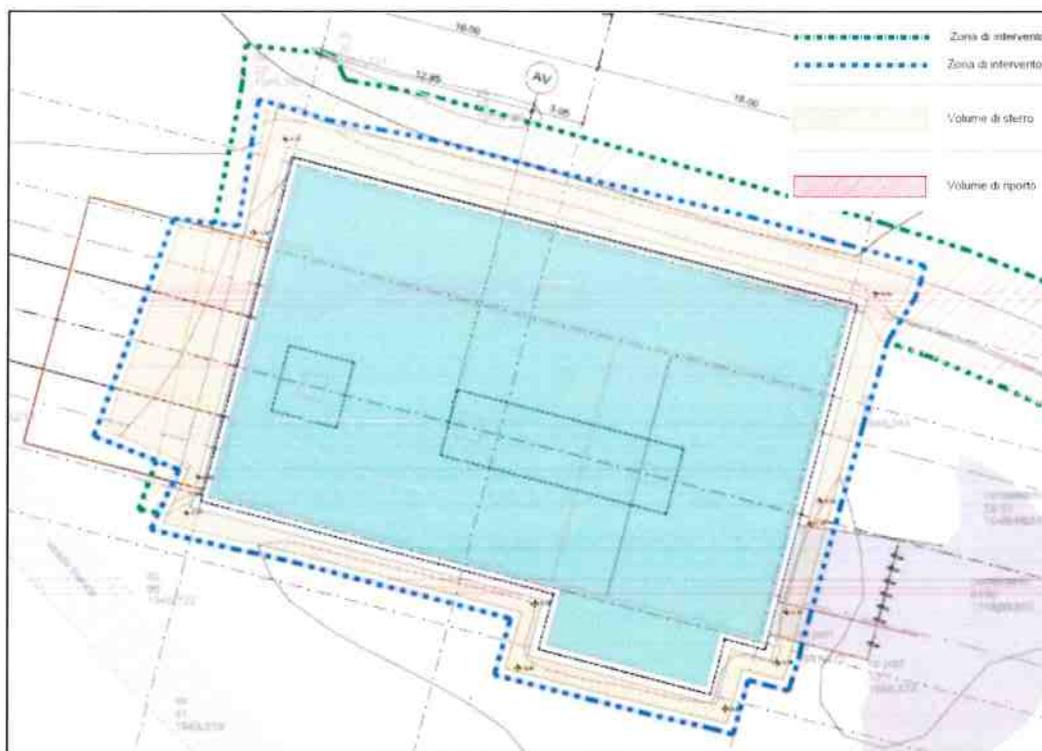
Stralcio planimetria di scavo stazione di valle (da elaborato 6.2.1).
